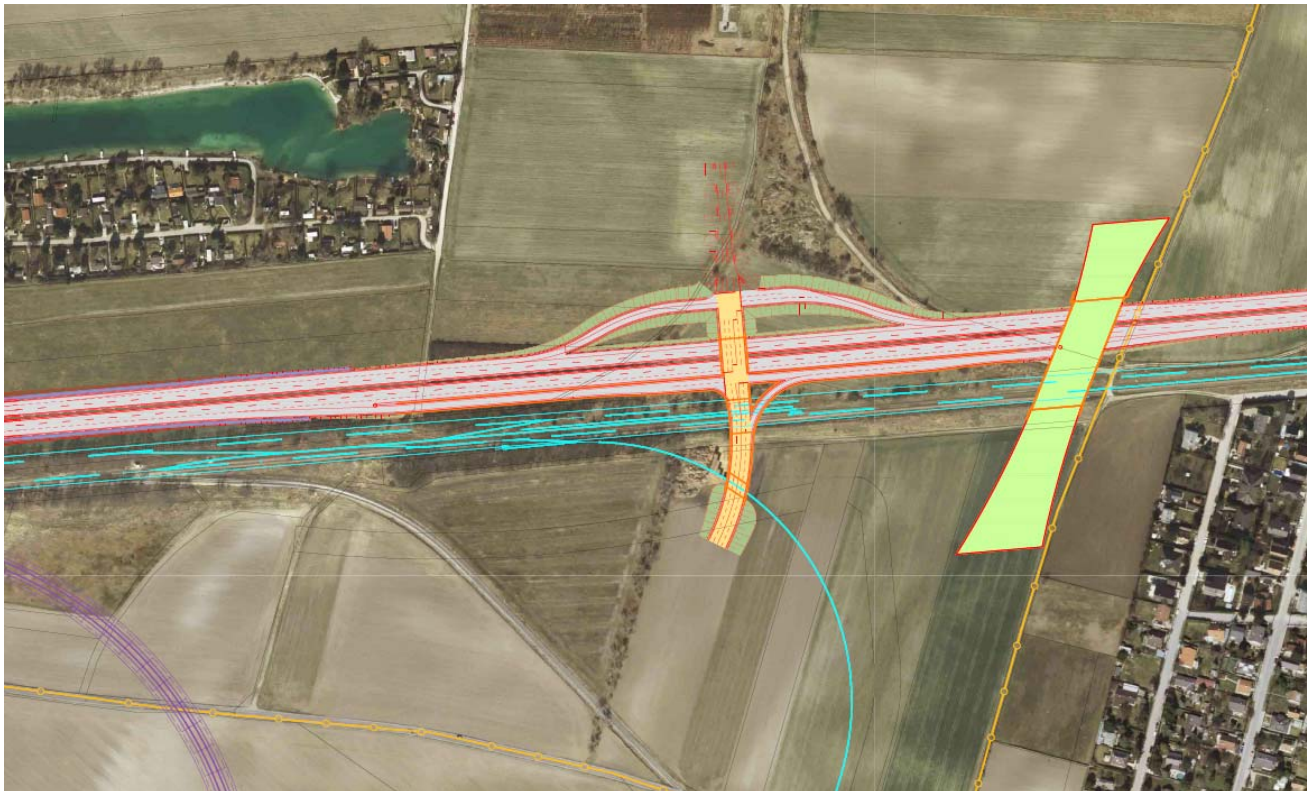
Ausschnitt Lageplan – Technisches Projekt, Einreichprojekt S 1 Spange, Quelle: Werner Consult / IKK
